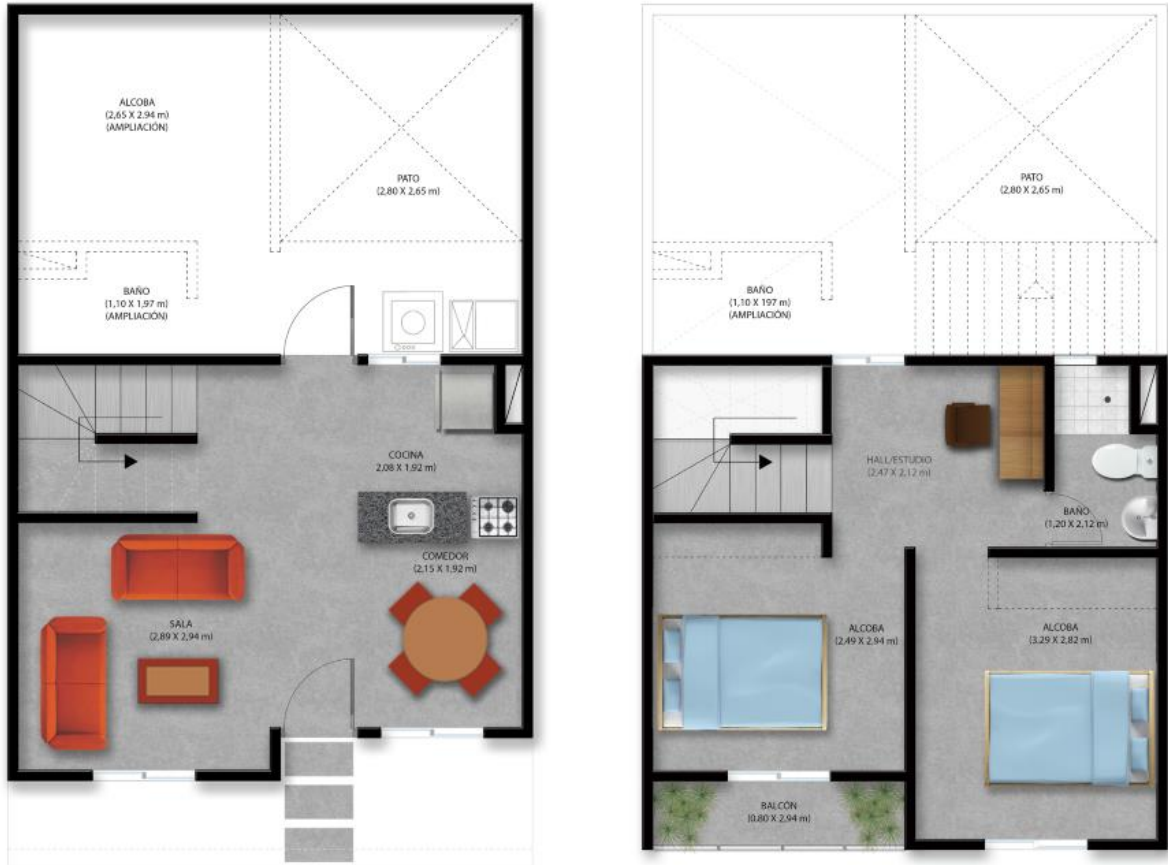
Planta primero y segundo piso vivienda unifamiliar.
